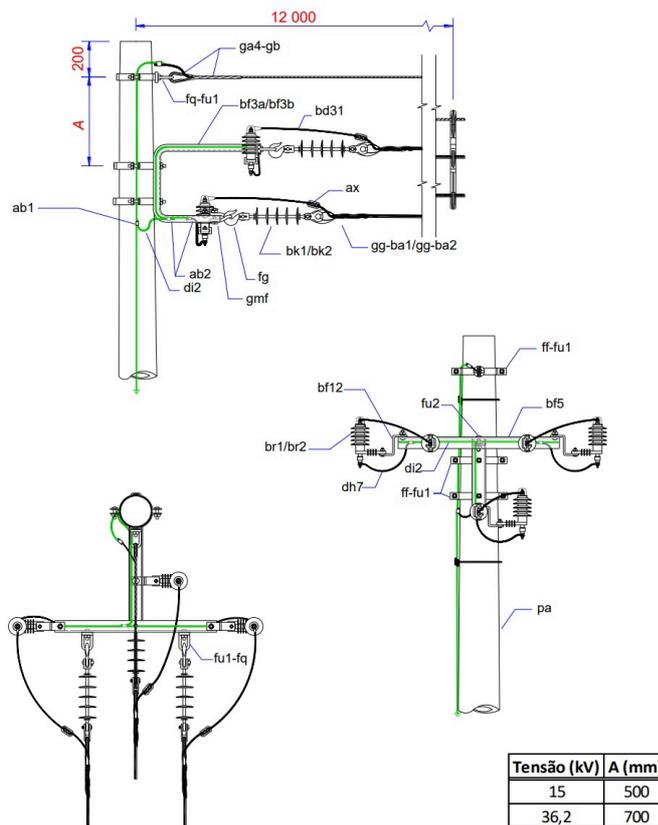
ESTRUTURA CE2 - REDE COMPACTA
